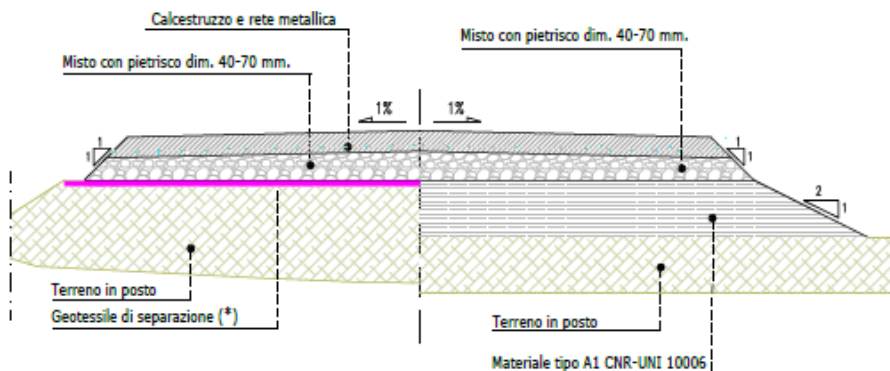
Sezione stradale tratti in rilevato ($p > 13\%$)
